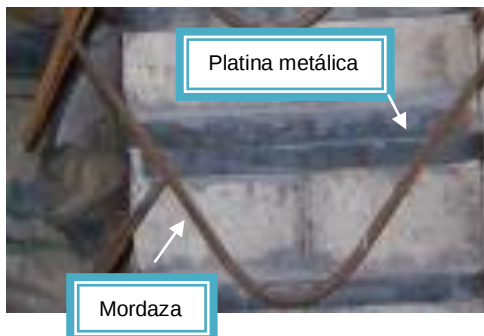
Detalle de las Platina metálica con Espesor: 3/16", Grosor: 1", Detalle de las Mordazas de hierro de 1/2".
